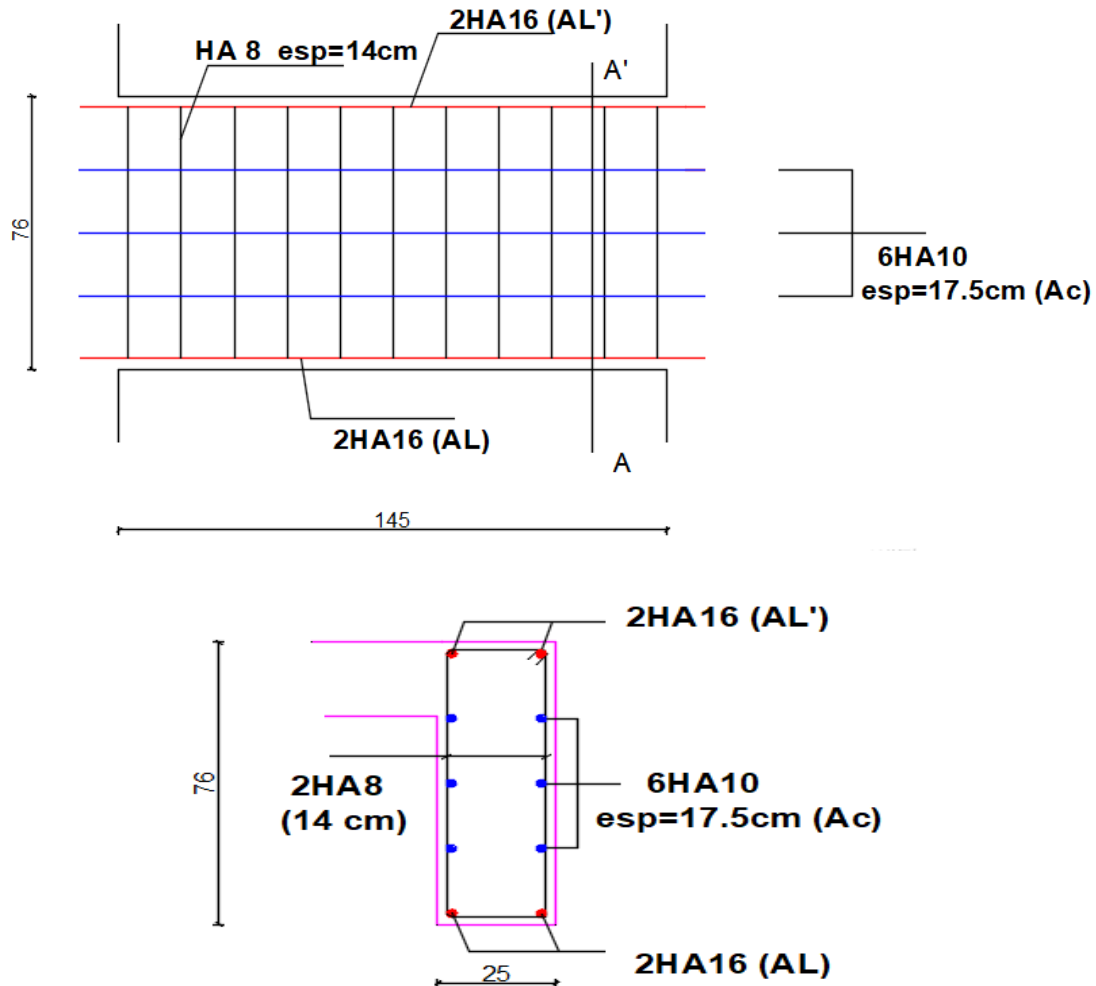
Schéma de ferrailage Linteau 1
